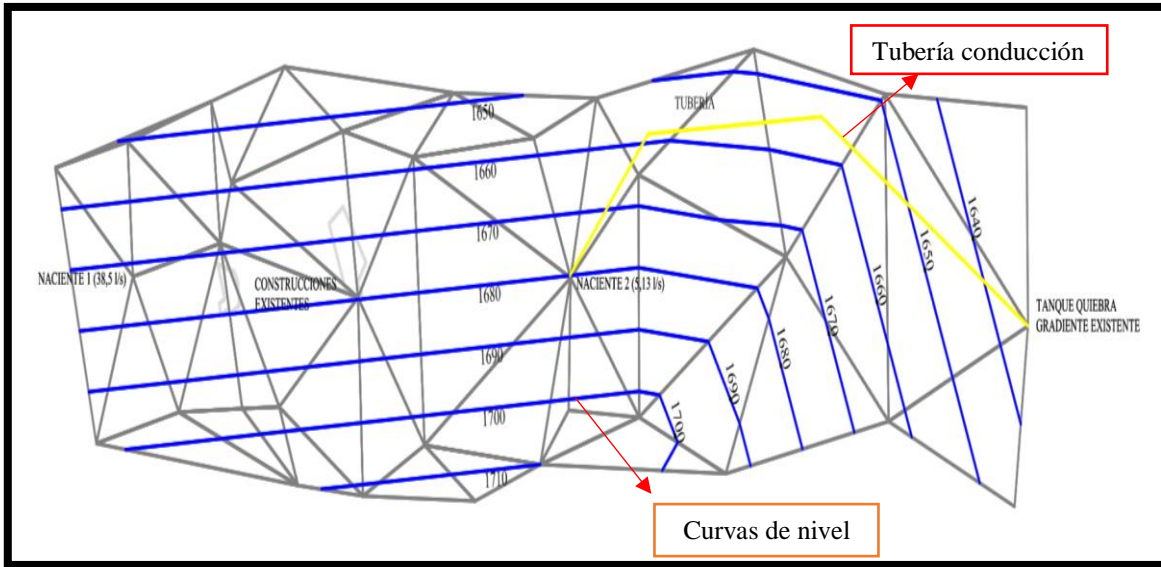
Planta del perfil 2 de la tubería de conducción, 2013.
